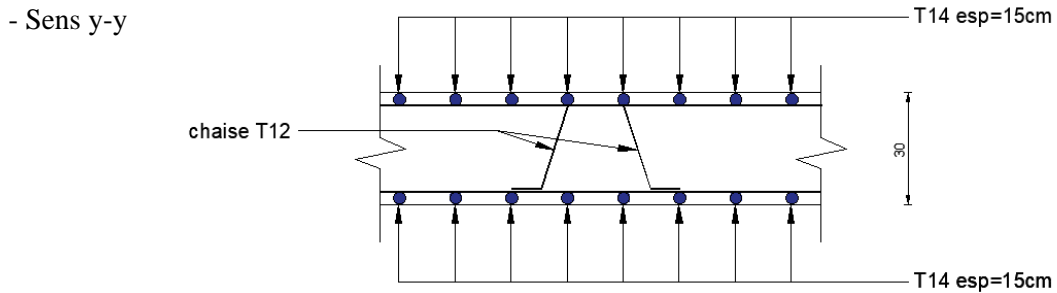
Schéma de ferrailage de la dalle du radier sur appui sens y-y.
